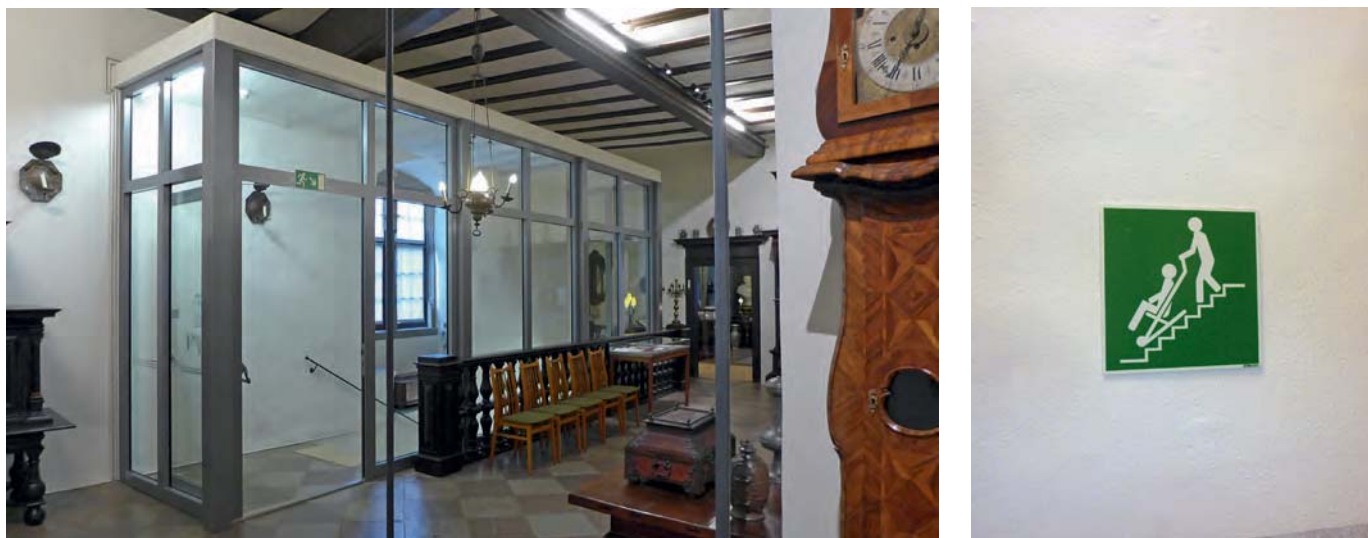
, b Barrierefreiheit im öffentlich zugänglichen Baudenkmal: Brandschutzabschottung eines Treppenraumes, Piktogramm Evakuierungsstuhl – im Brandfall kann der Aufzug nicht genutzt werden (Fotos: Klaus-Jürgen Edelhäuser)
